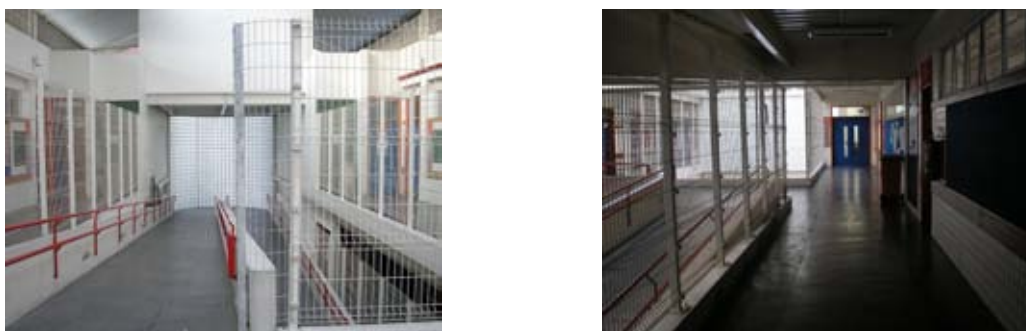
Grades nas rampas, circulações e vão de abertura do 2º e 3º pavimento.
